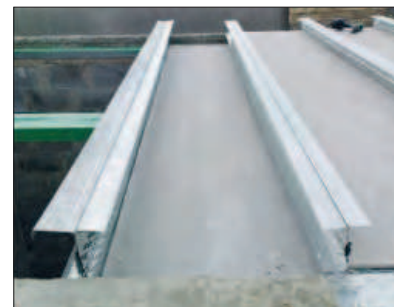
Фрагменты конструкций стен и плоского перекрытия
